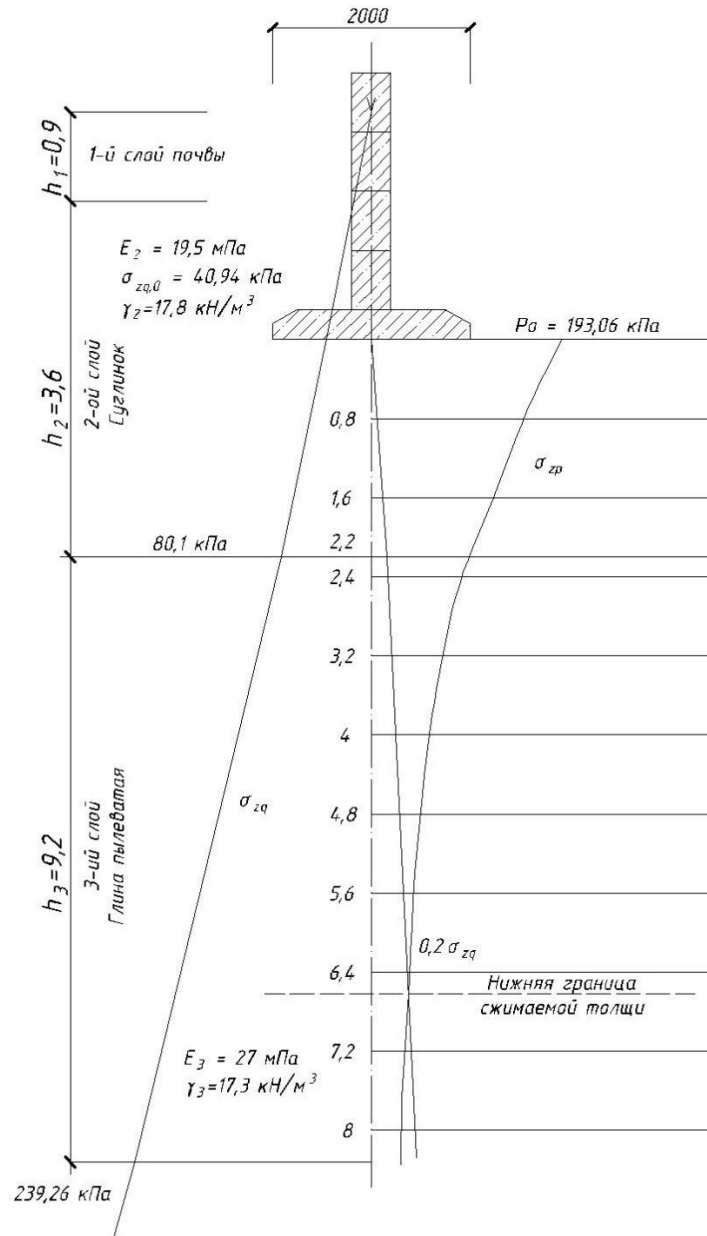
Расчетная схема осадки ленточного фундамента второго типа
